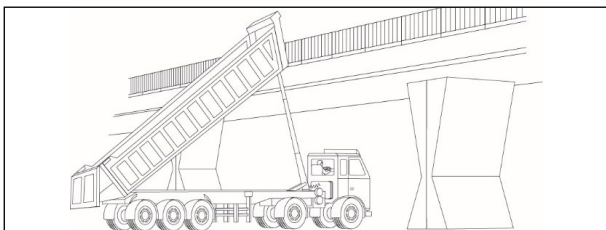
Impacto de la caja contra un puente al circular con la caja elevada.
